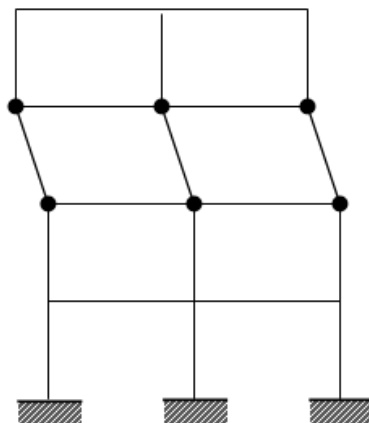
Mécanisme possible de rupture d'un étage par rotule plastique dans les poteaux
